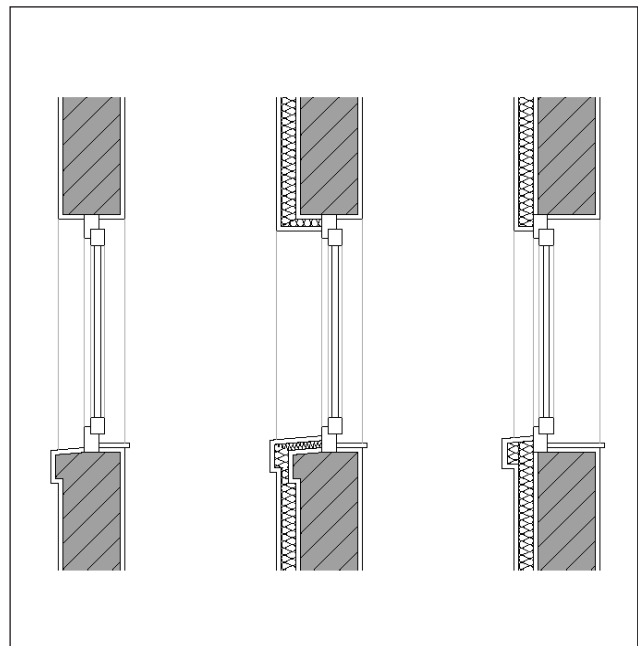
Nachbildung von Fassadenelementen in WDVS als Systemschnitt
